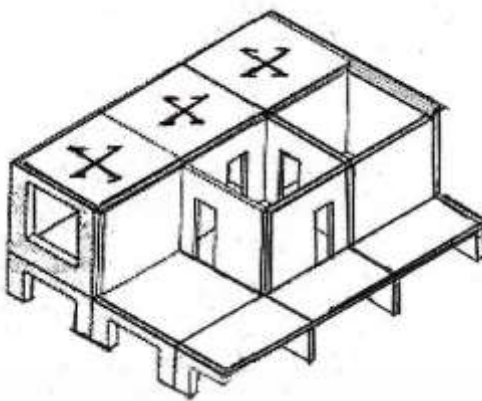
การวางชั้นส่วนผนังด้านหน้าวิธีต่างๆ ในระบบ Cross Wall [8]
